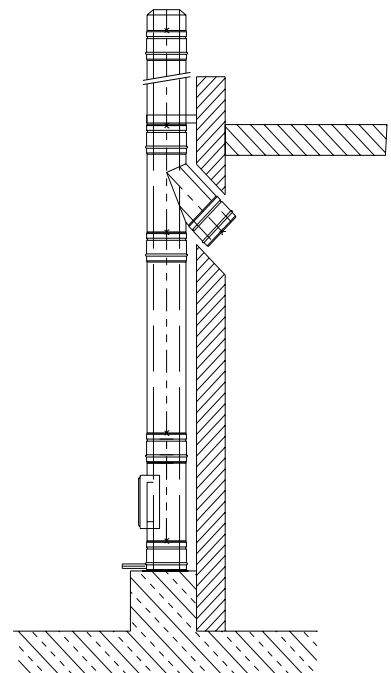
Aufbau mit Grundplatte für Sockelmontage
